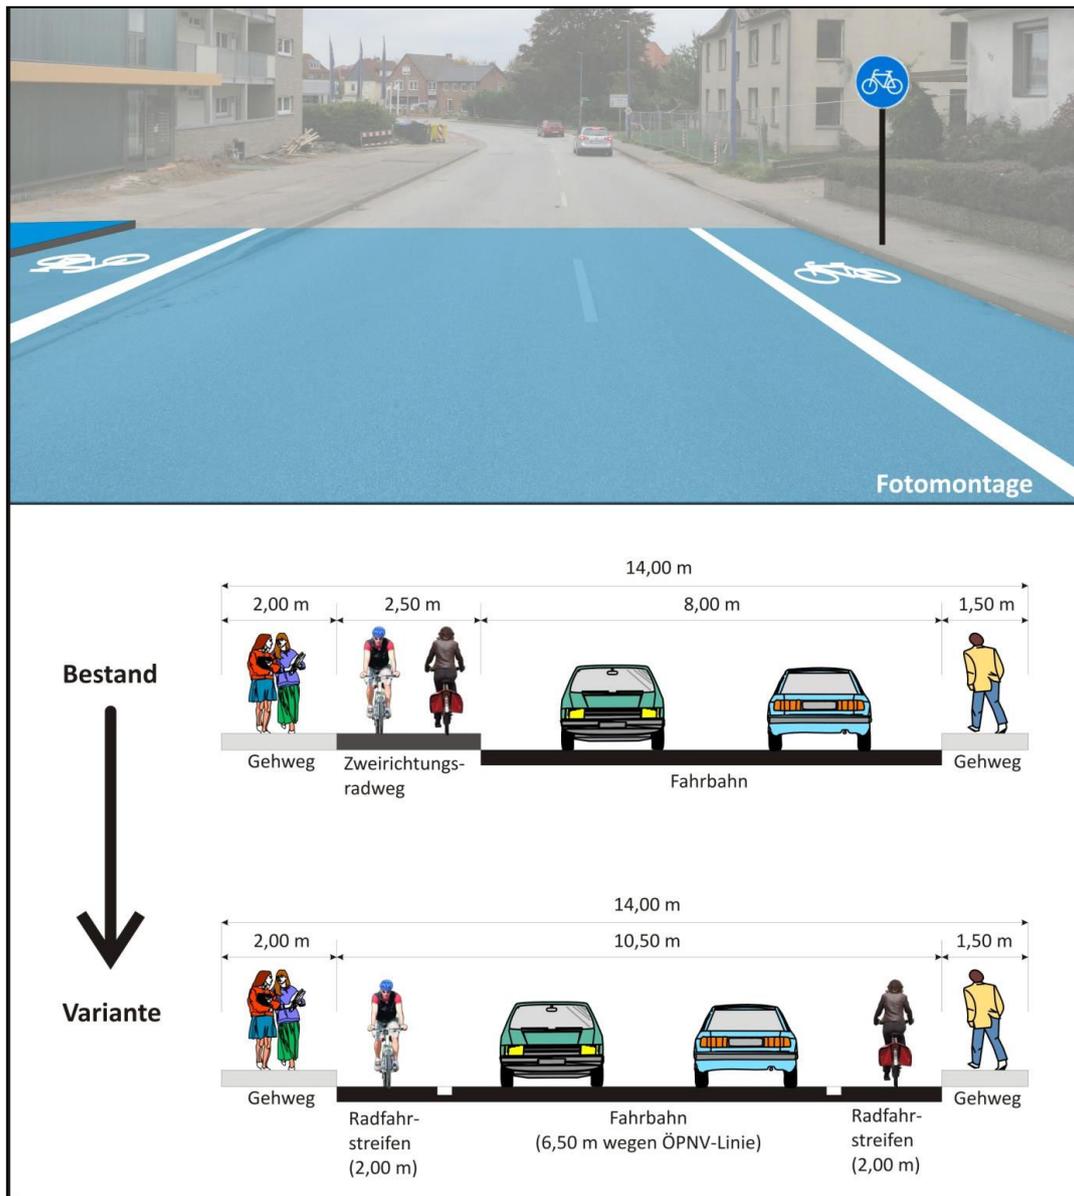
Anpassung des Straßenquerschnitts, Rendsburger Straße (M 9)
